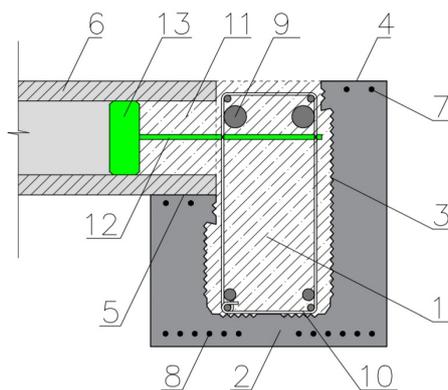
Сборно-монолитный железобетонный ригель каркасного здания: 1 - монолитный ж/б пояс; 2 - полка; 3- рифленая поверхность; 4 - неопорное ребро ригеля; 5 - опорное ребро ригеля; 6 - плита перекрытия; 7 и 8 - предварительно-напряженная арматура; 9 - дополнительная ненапрягаемая арматура; 10 - арматурный каркас; 11 - армированные шпонки; 12 - деталь; 13 - заглушки.
